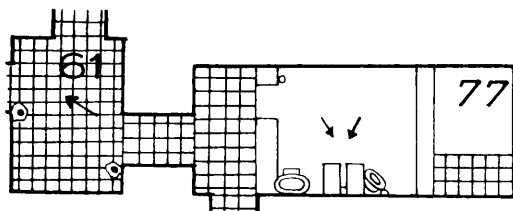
Salles 61 et 77 (salle de bains, w.-c.).
